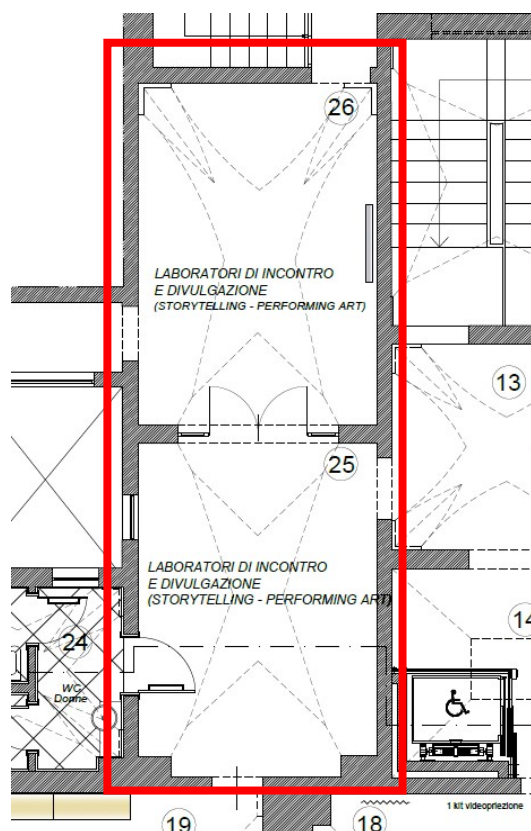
Stralcio della planimetria del piano primo con individuazione delle sale 25 e 26 (in rosso)
